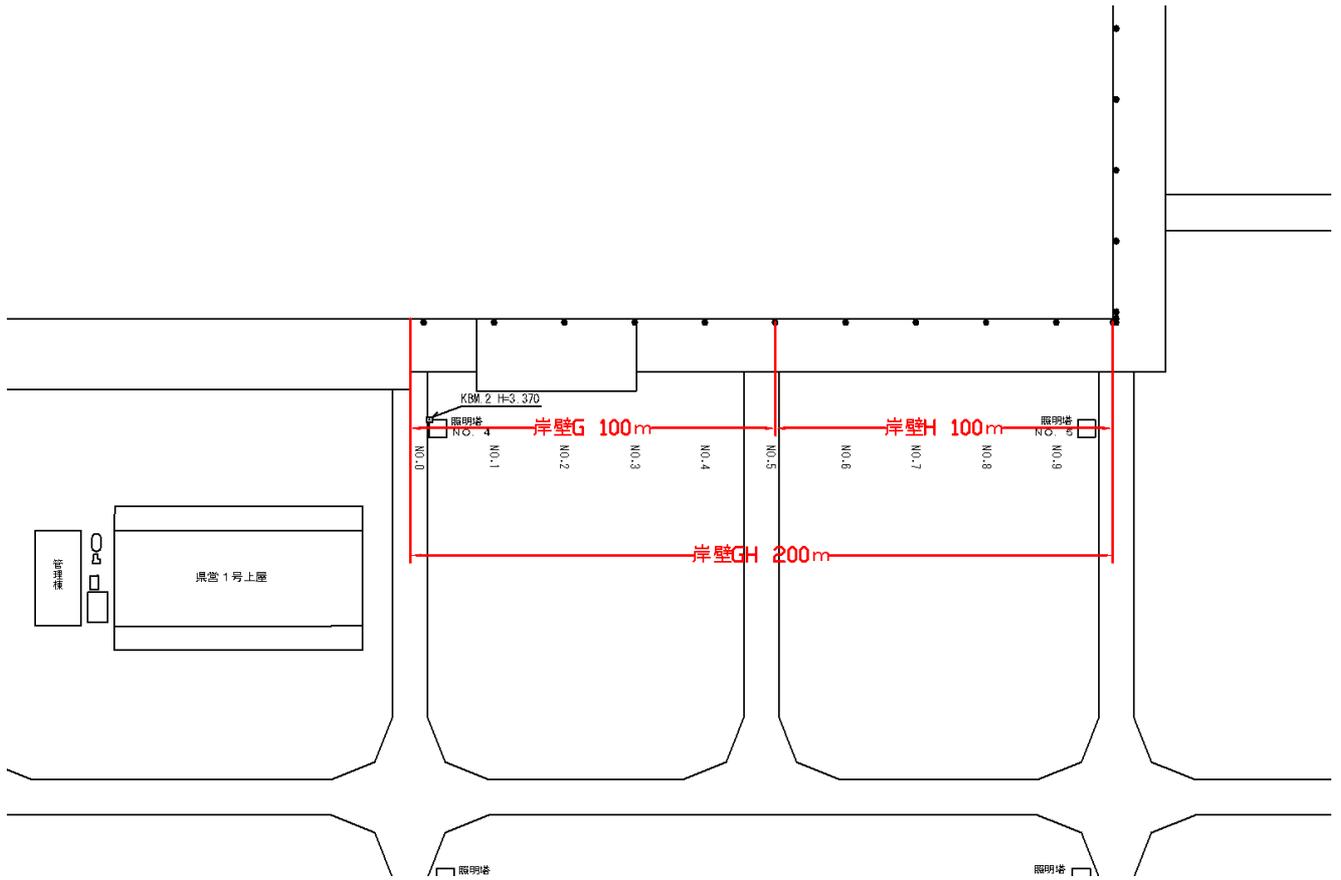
215 No.17 常陸那珂港区_北ふ頭地区岸壁 (-5.5m) G、H の平面図 (被災前)
